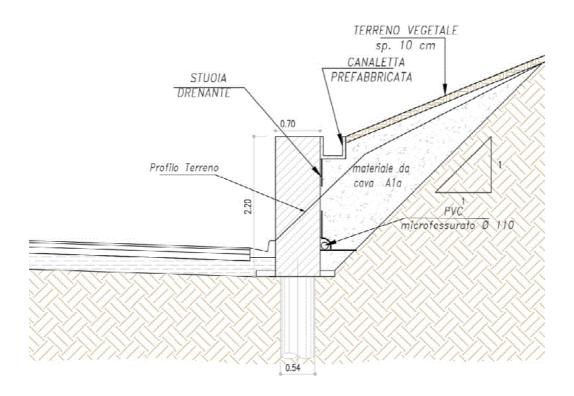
Muro di controripa tratto stradale da sez. 57 a sez. 66
